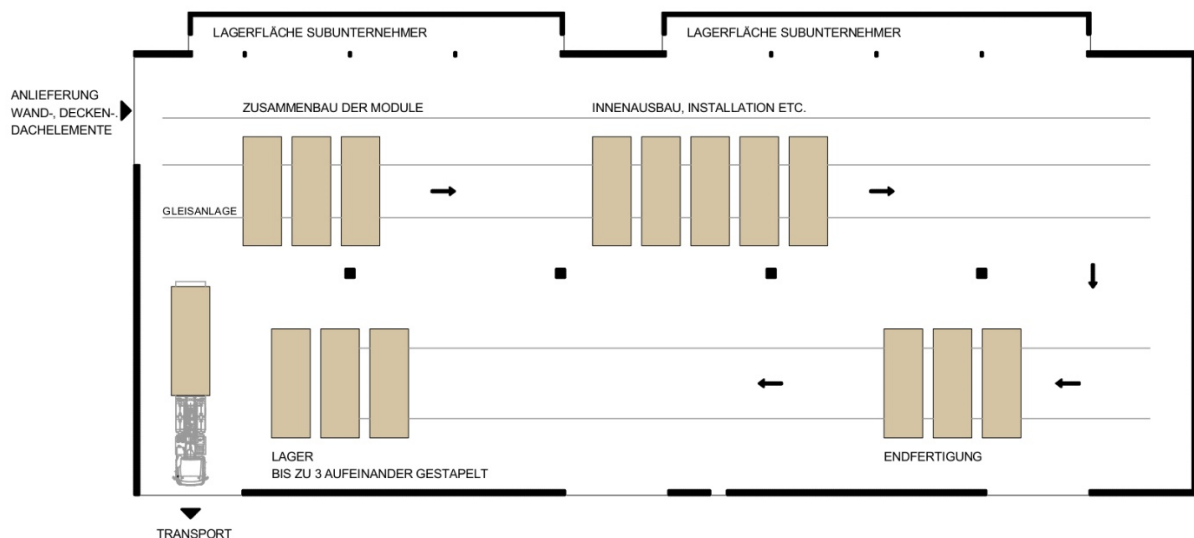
Produktionsabläufe, beispielhafter Grundriss einer Werkhalle, Holzbauunternehmen Kaufmann Zimmerei und Tischlerei, Reuthe / Vorarlberg
